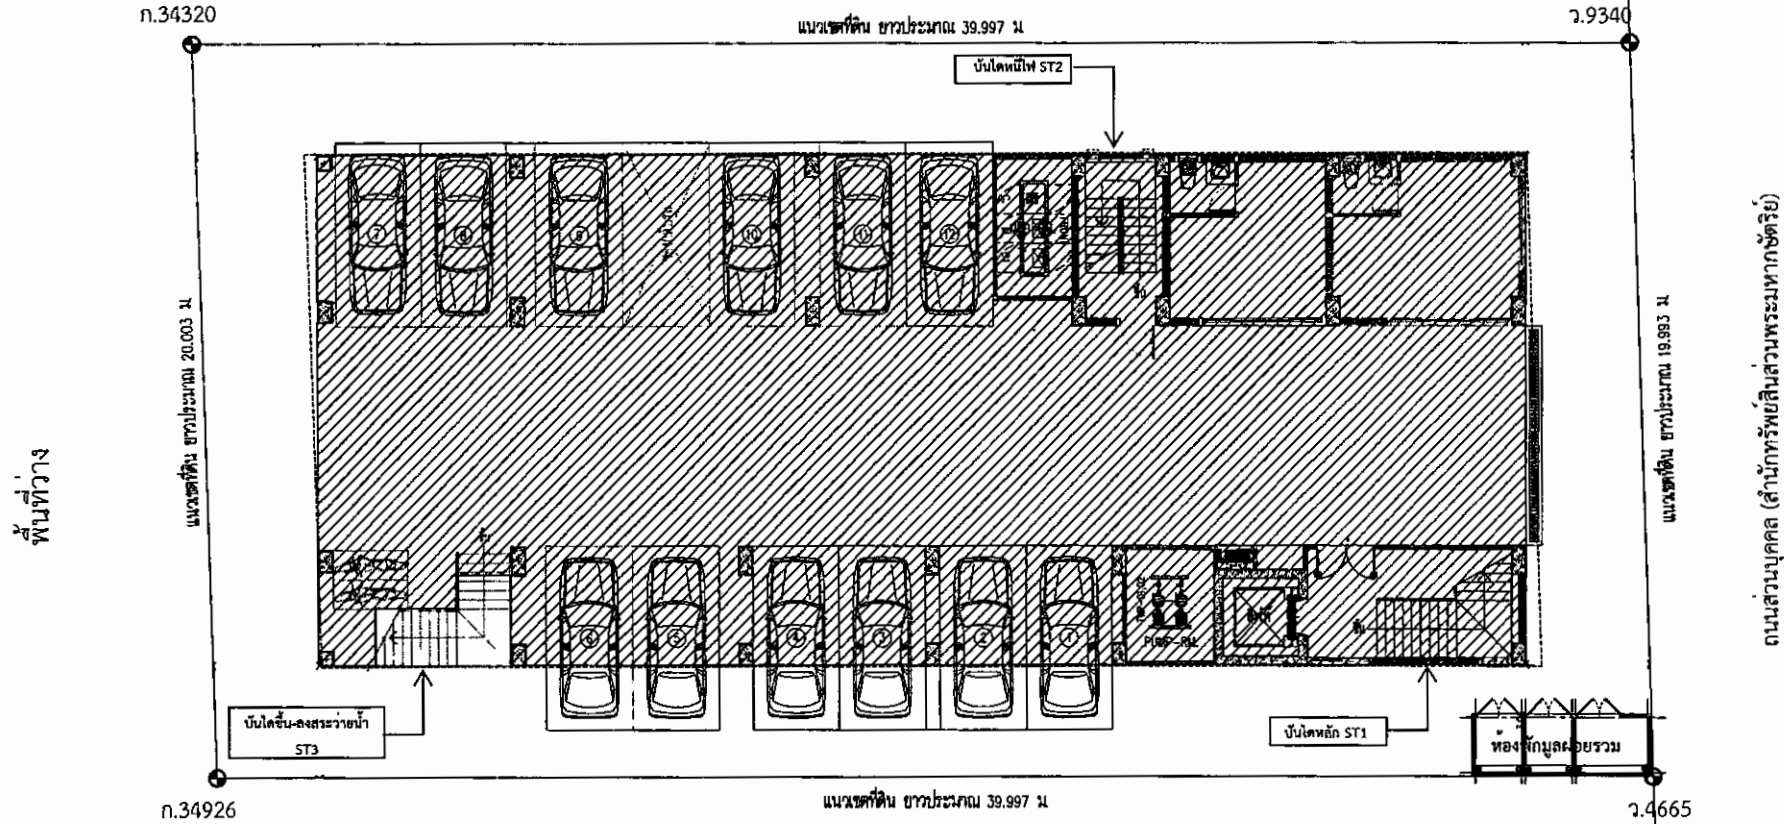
แสดงผังบริเวณระยะก่อสร้างของโครงการ
